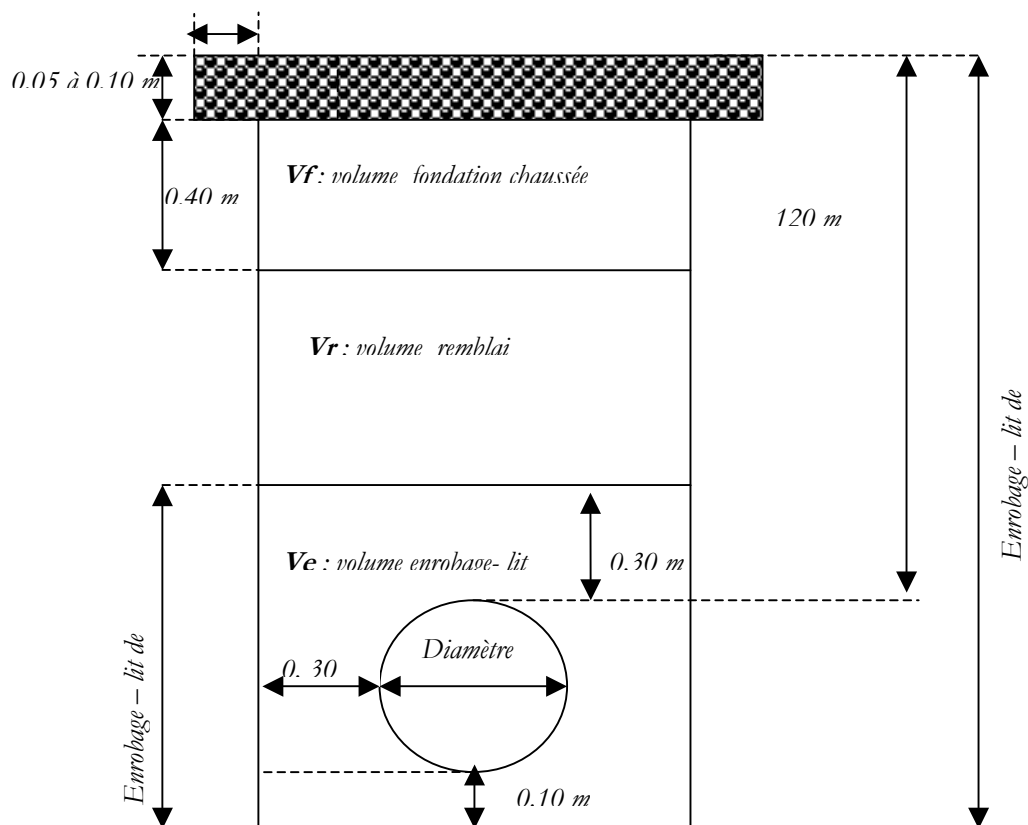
Coupe de fouille retenue pour les travaux de terrassement et pose d'une conduite neuve (Janel et al., 2001)
